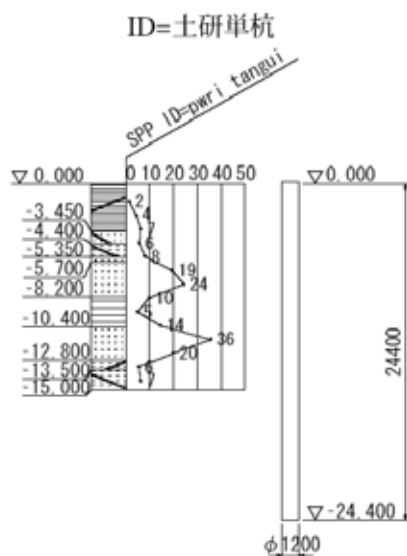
ボーリング柱状図 (単杭その3 単位: mm)
